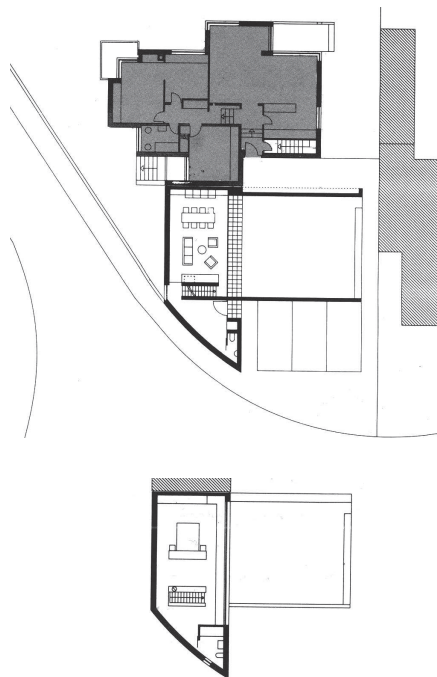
Plans du rez de chaussée (au dessus) et de l'étage; dessins de l'agence Snozzi
